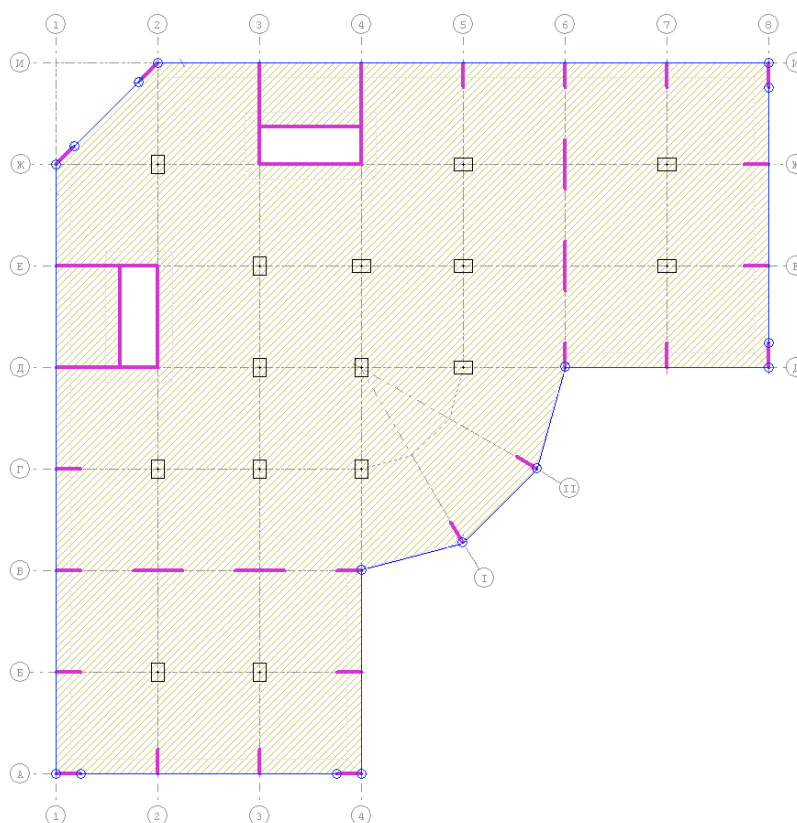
Плита перекрытия и линейные нагрузки
